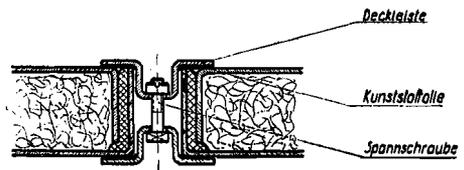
Wandplatte aus Stahlblech, Montage mit Spannleisten
